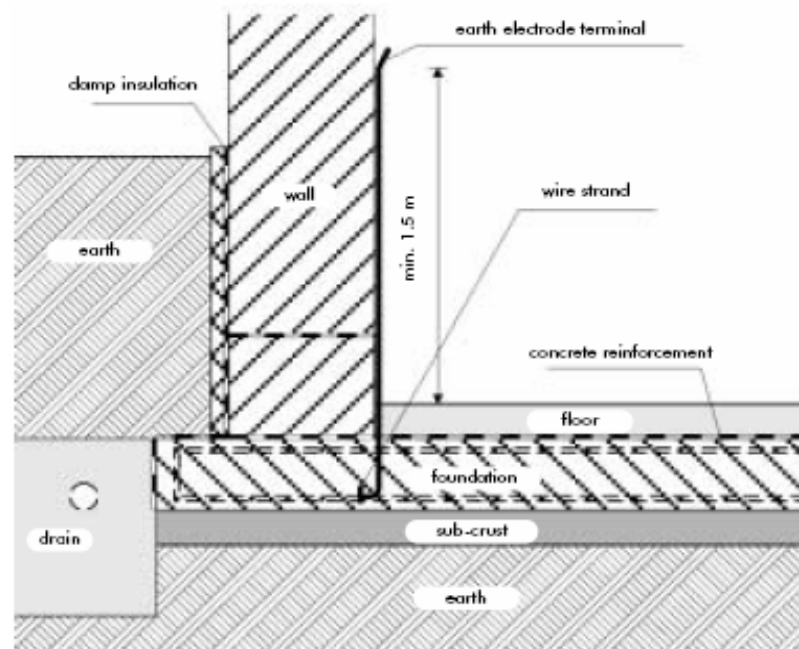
Electrode de terre dans des fondations en béton armé
